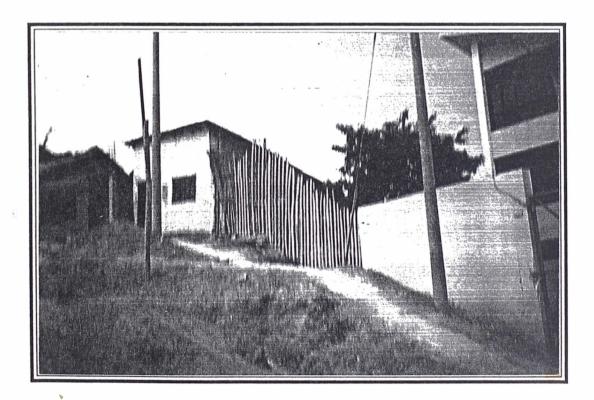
Vista del cerco frontal de la Planta de Tratamiento, consiste de una pared pequeña de concreto, al lado de las viviendas sin ningún tipo de protección por lo que es facil el acceso a este propiedad.
